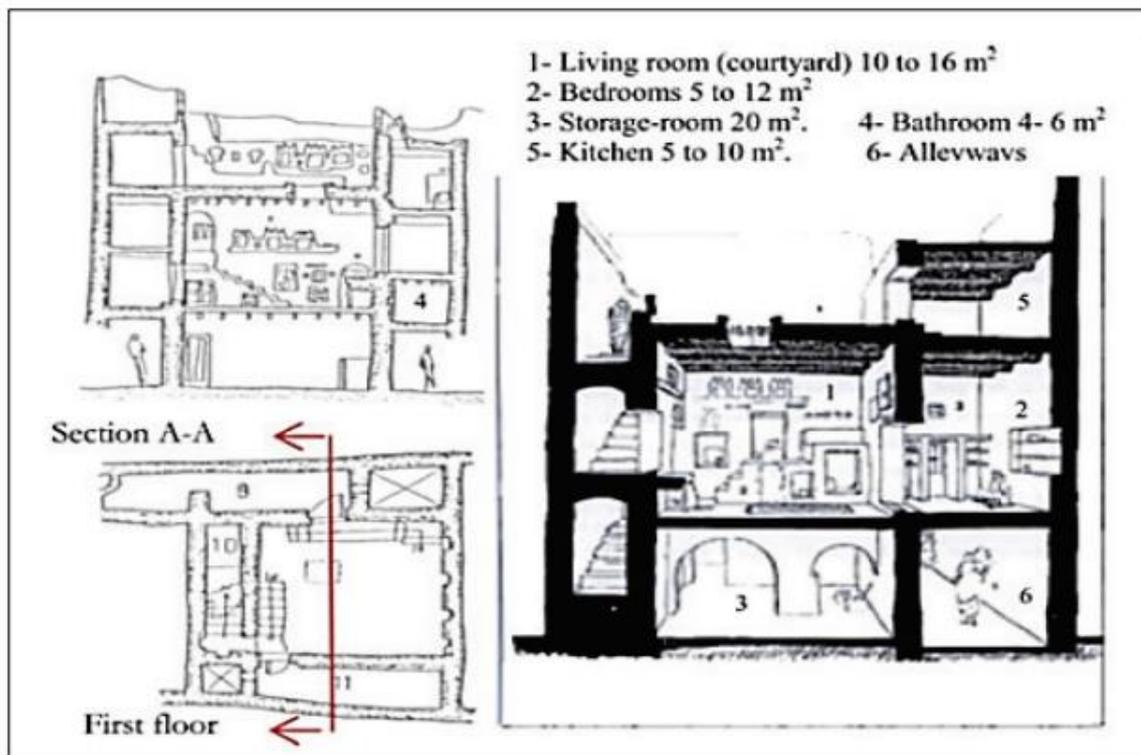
Plan et coupes de l'ancienne maison de Ghadamès (Source : Ealiwa,2000)
